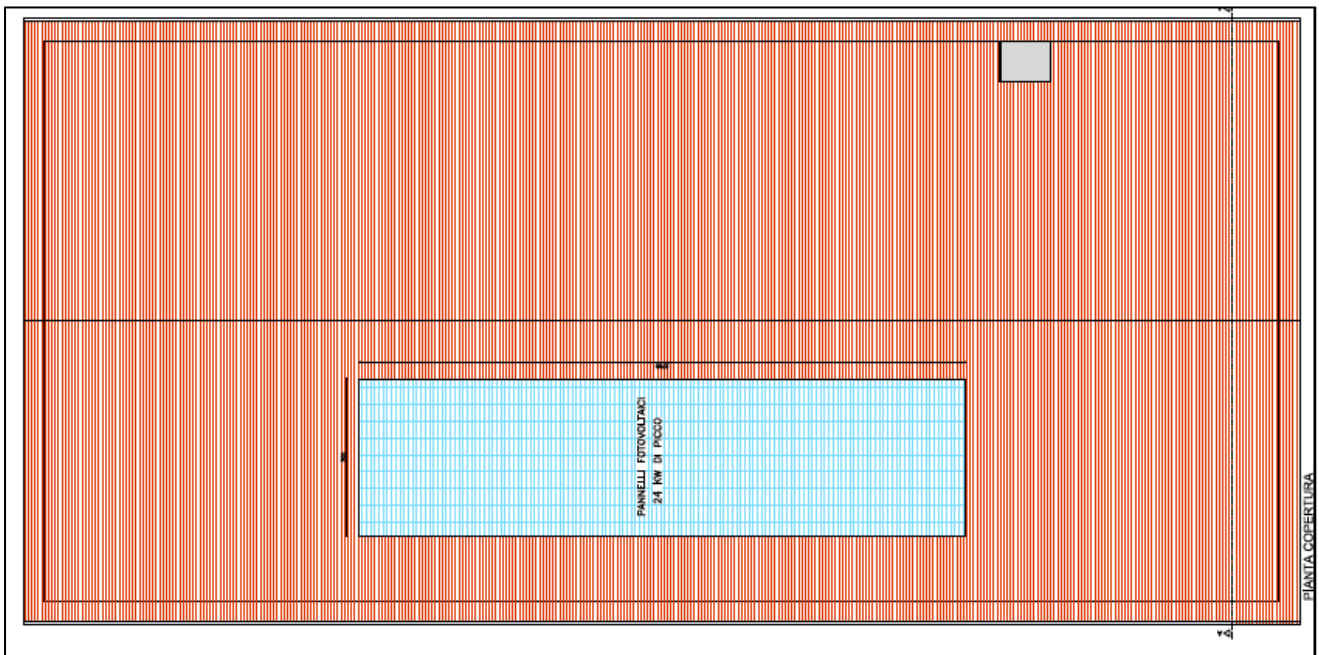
Planimetria stato di progetto copertura (estratto tavola n.6 – progetto piante)
